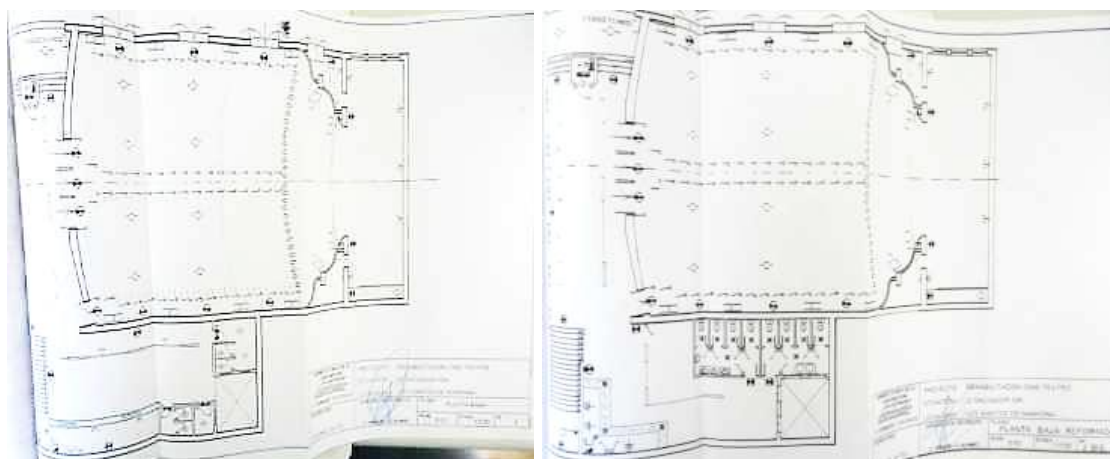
Planta baja Cinema Chueca de Madrid (Anasagasti. Obra completa).
